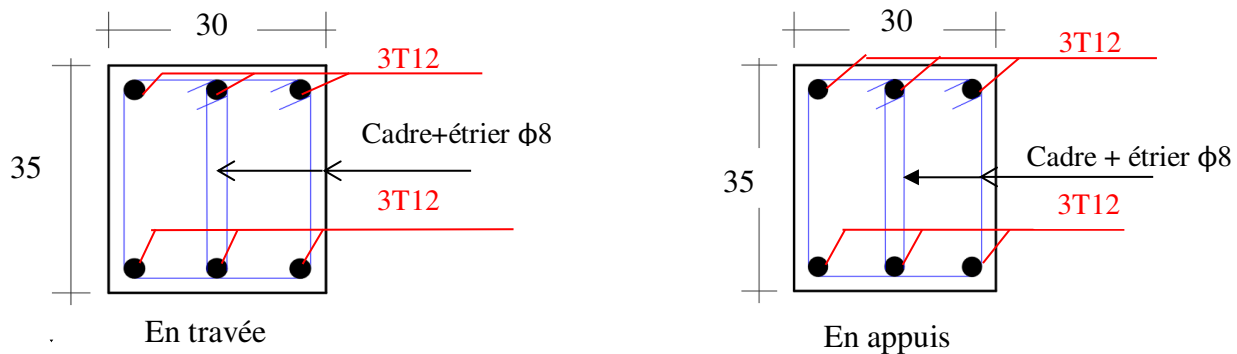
Schéma de ferrailage de la poutre palière
